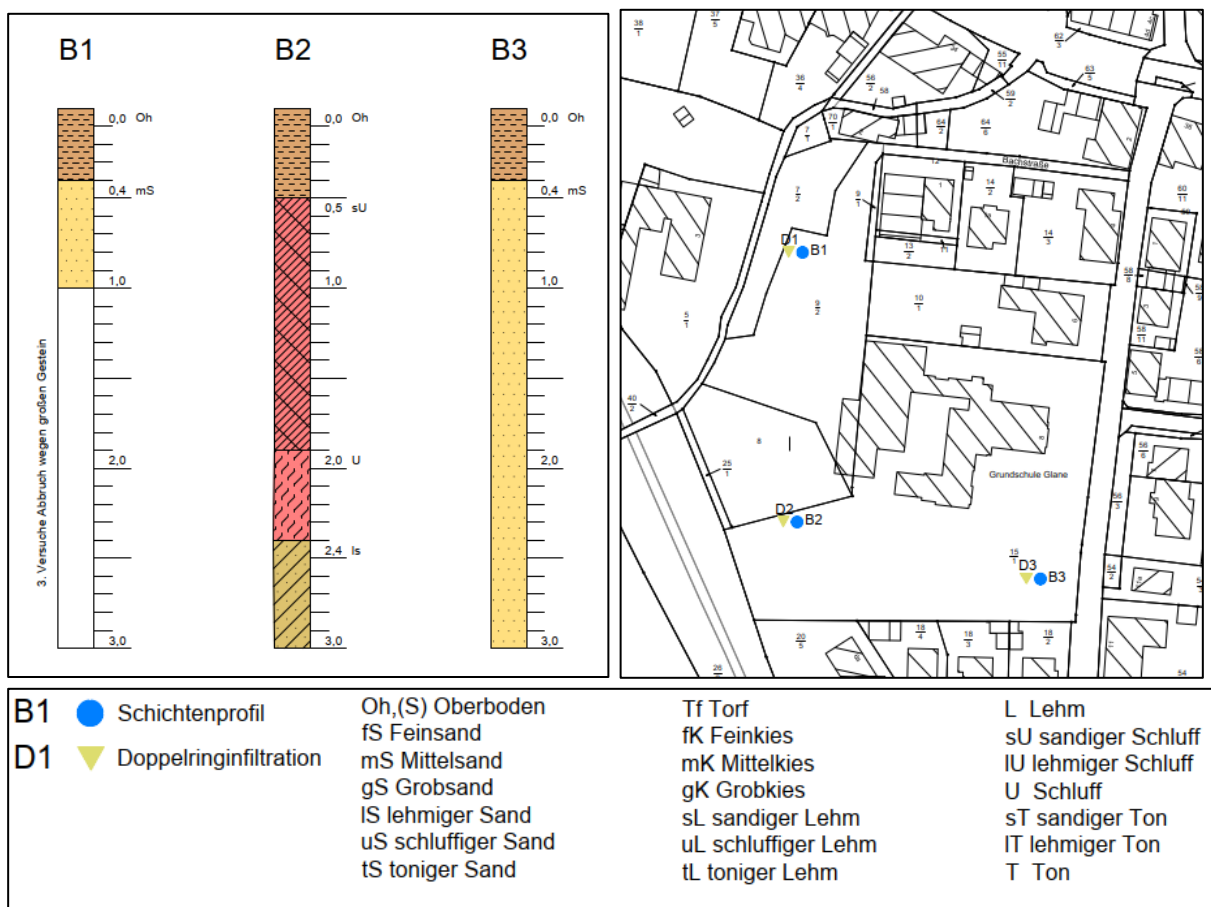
Lageplan und Schichtenprofile. IPW mit Darstellung der Bohr- und Infiltrationspunkten
